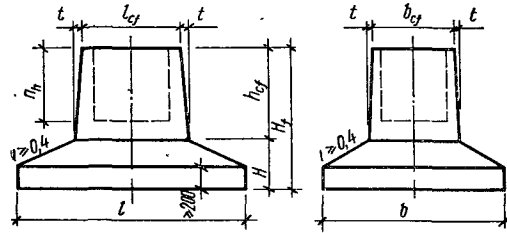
Сборный железобетонный фундамент ($t = 20 \dots 30$ мм при металлической и 50 мм — при деревянной опалубке).
